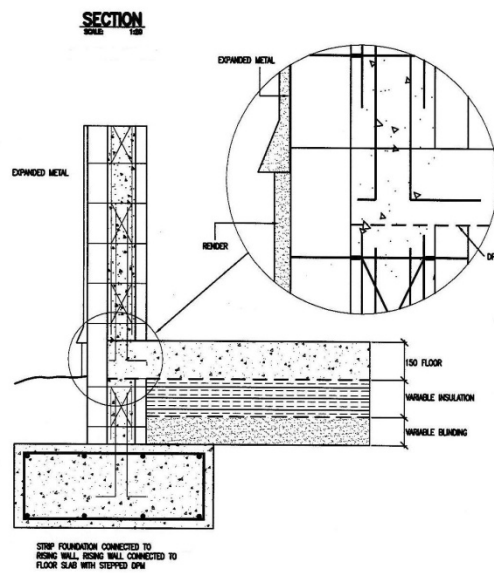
section verticale des armatures d'un PLASTBAU-3® et des liaisons avec semelle filante
